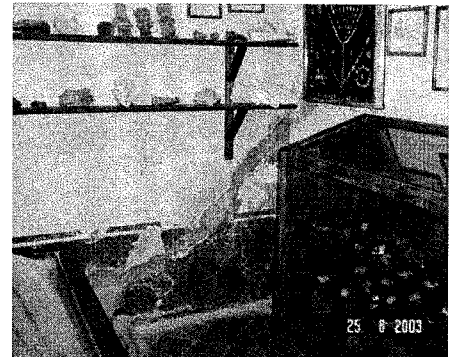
Fisura y humedad interior muro museo de sitio
